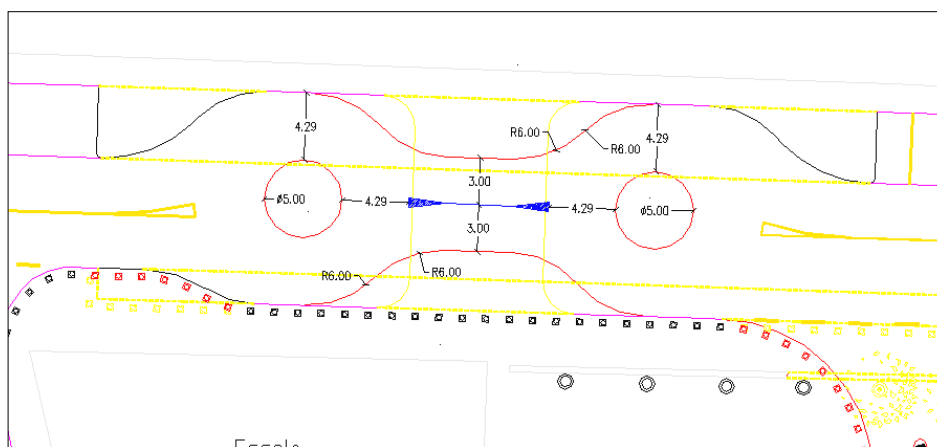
Pormenor das duas mini-rotundas previstas para a segunda fase do esquema de circulação.
